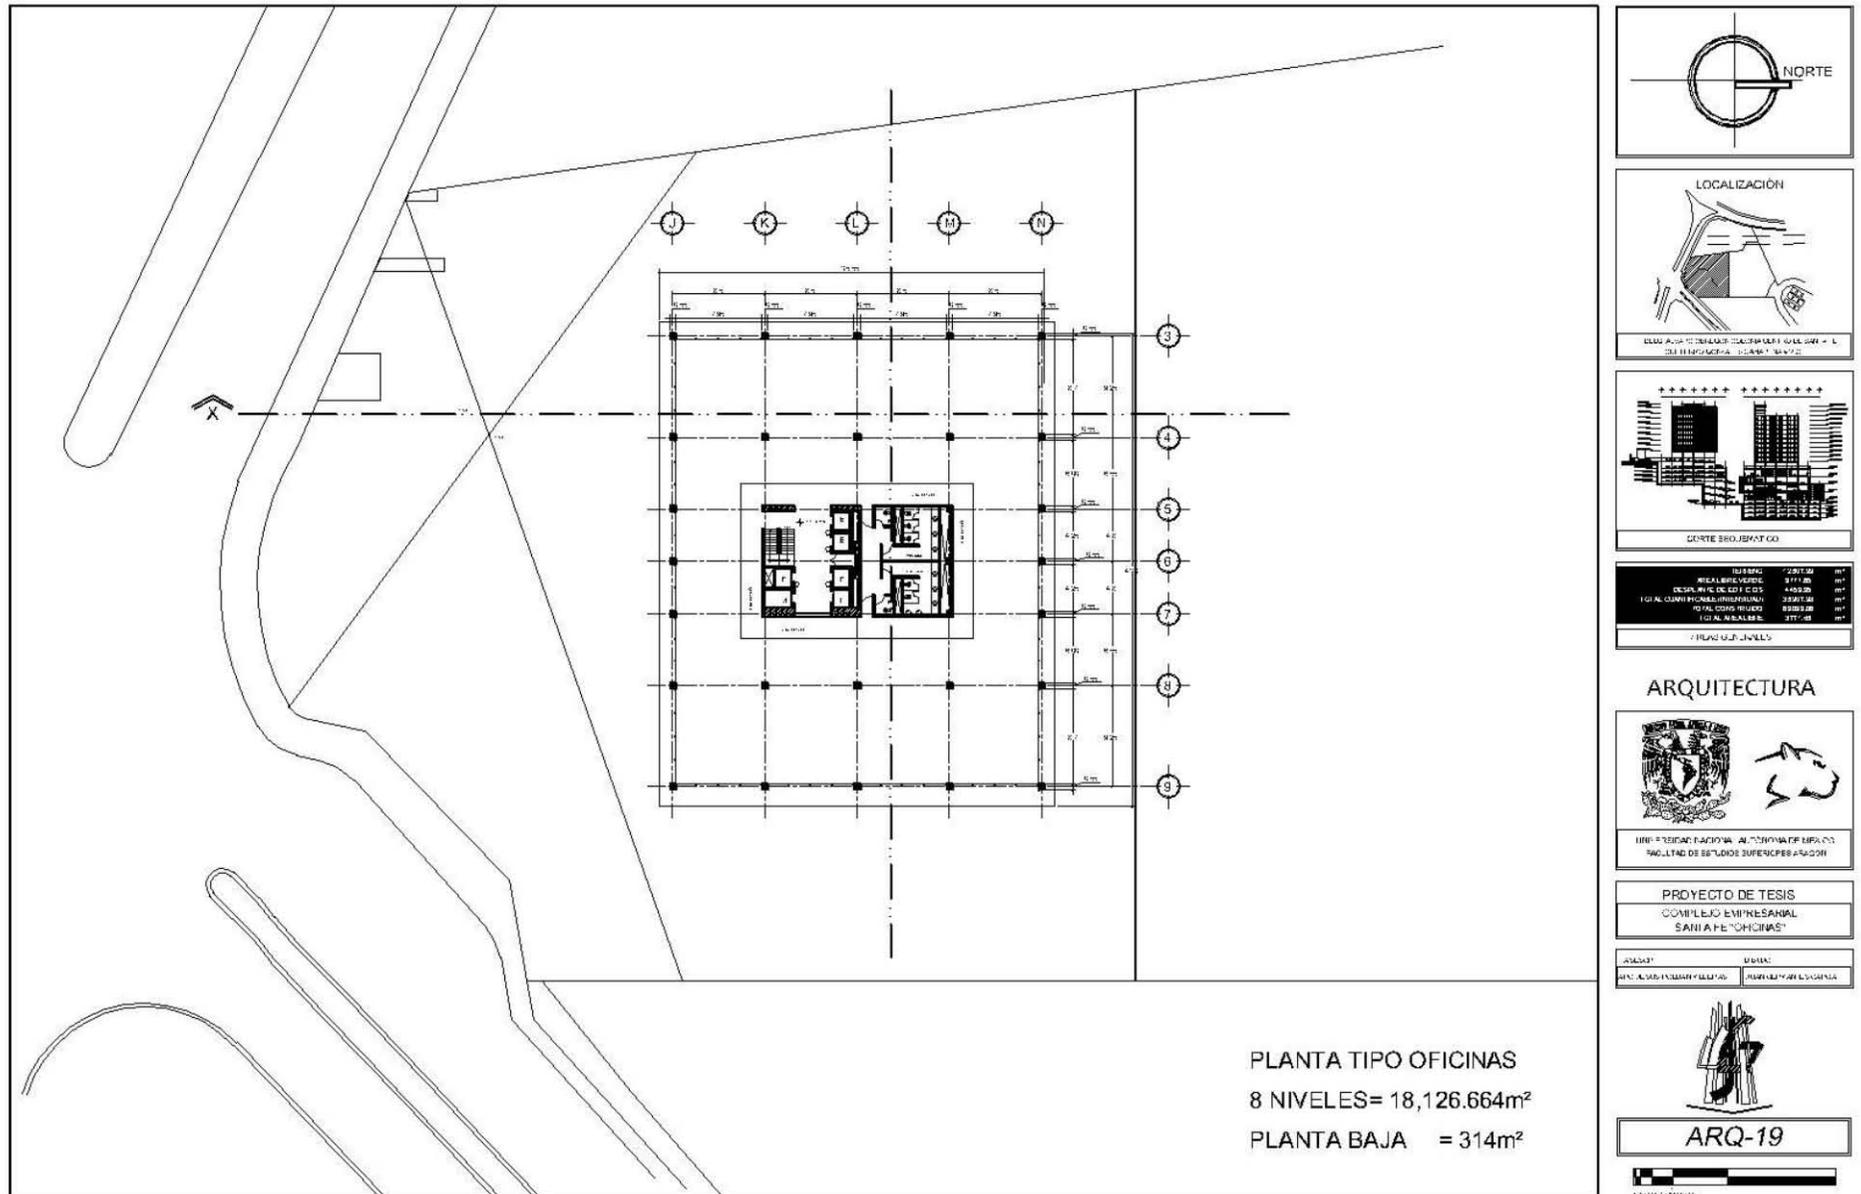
Plano ARQ-19; Planta Tipo Oficinas. Edición propia
